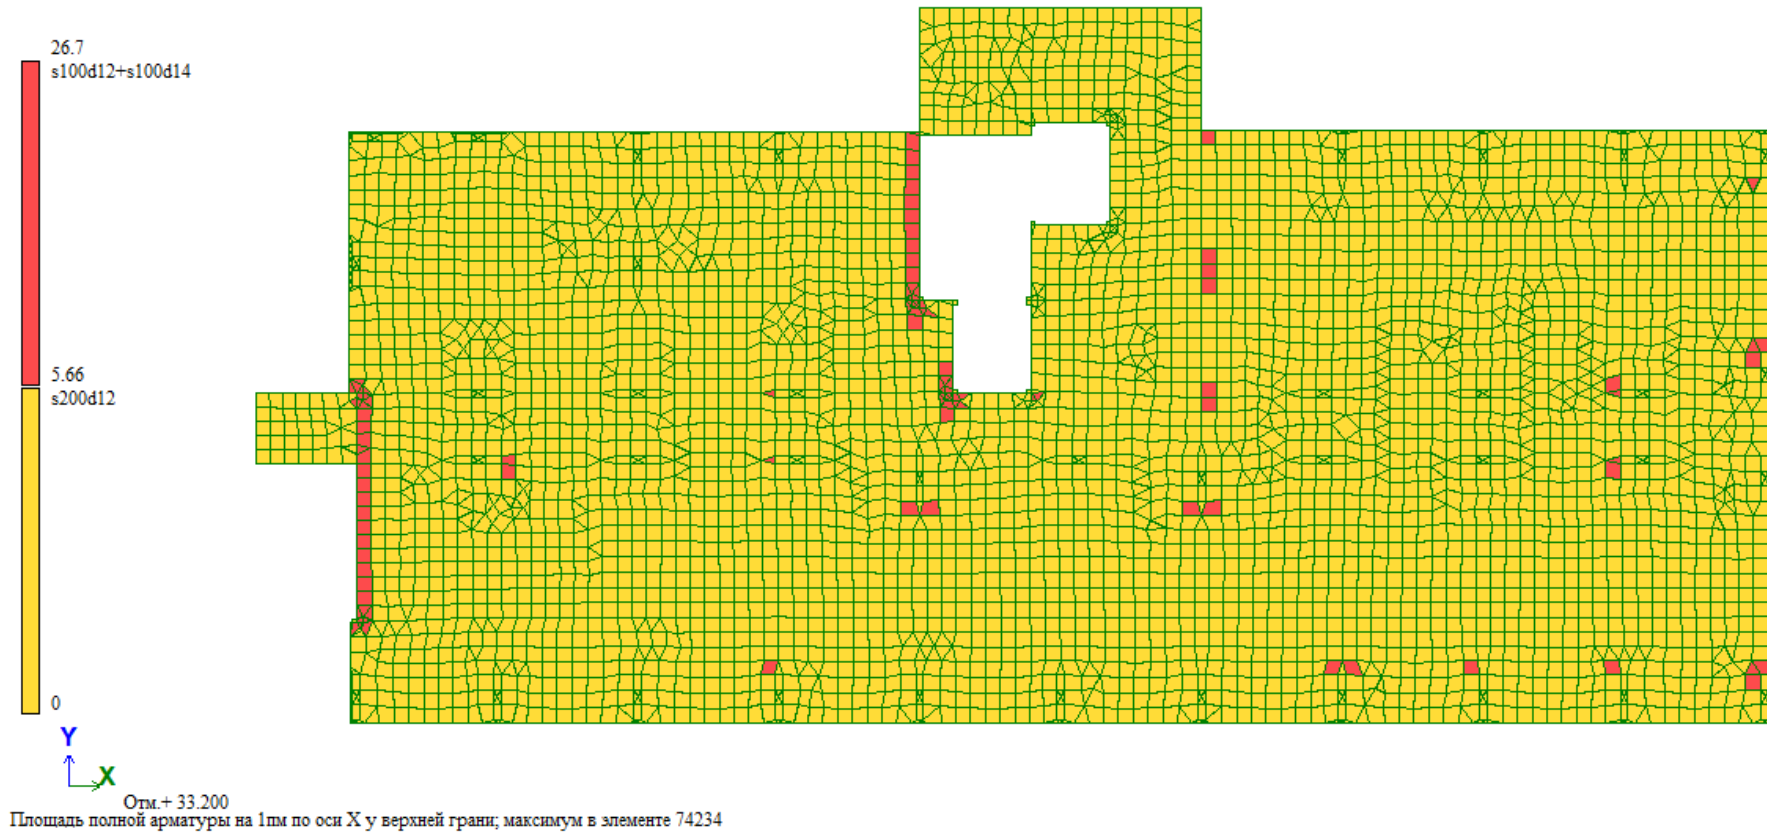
Площадь арматуры на 1м по X у верхней грани
